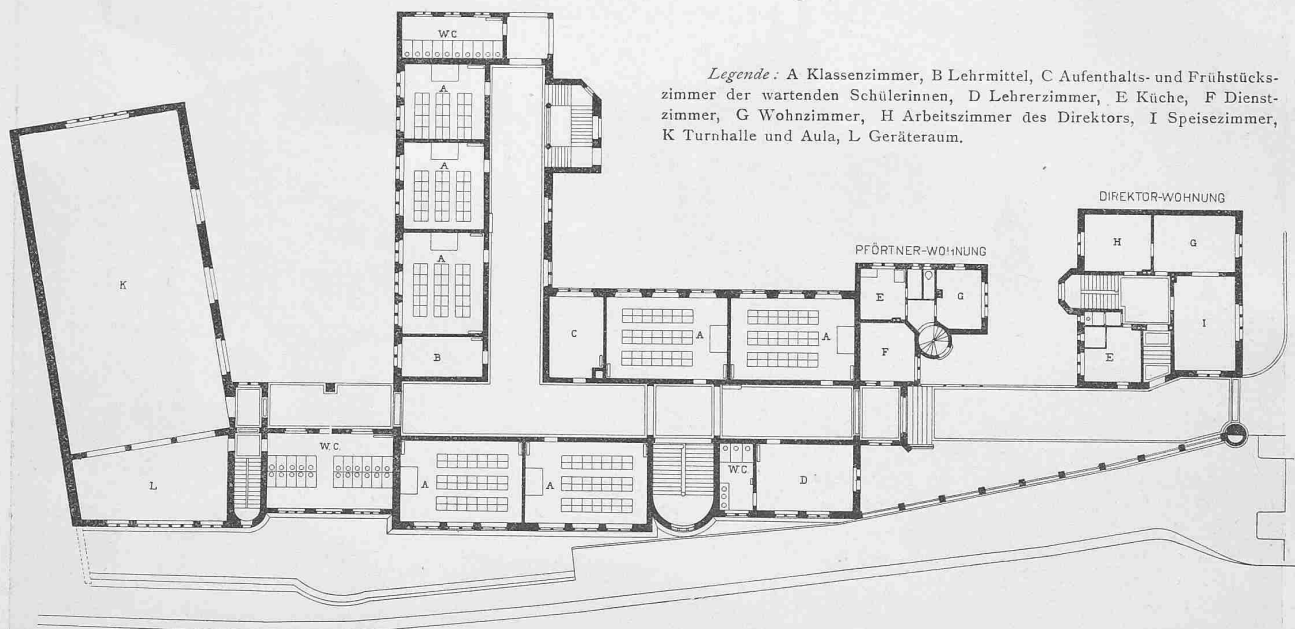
Grundriss vom Erdgeschoss. — Masstab 1:500.
